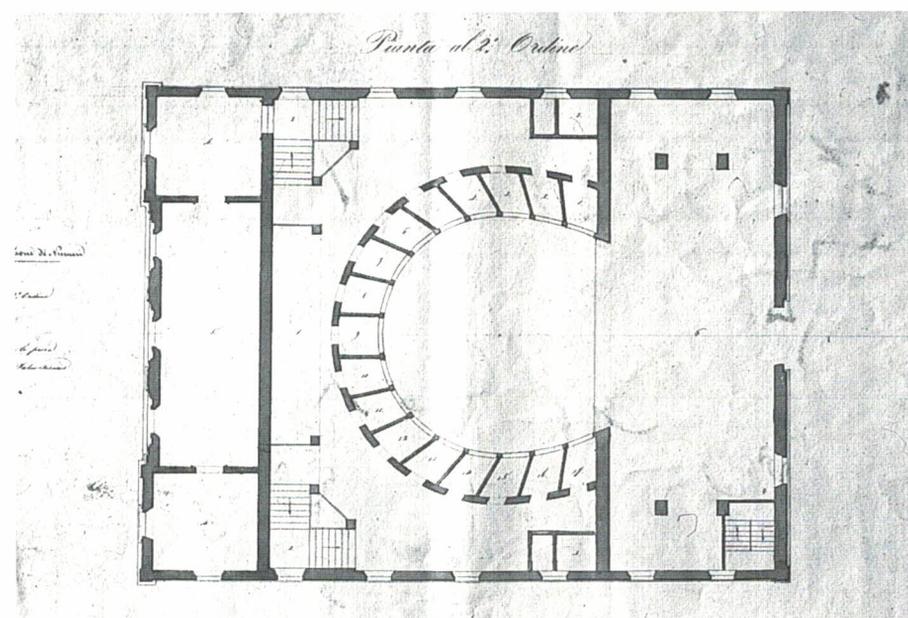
LONGIANO, *Archivio Comunale*. Progetto B. Abbati (1850); pianta tipo.
